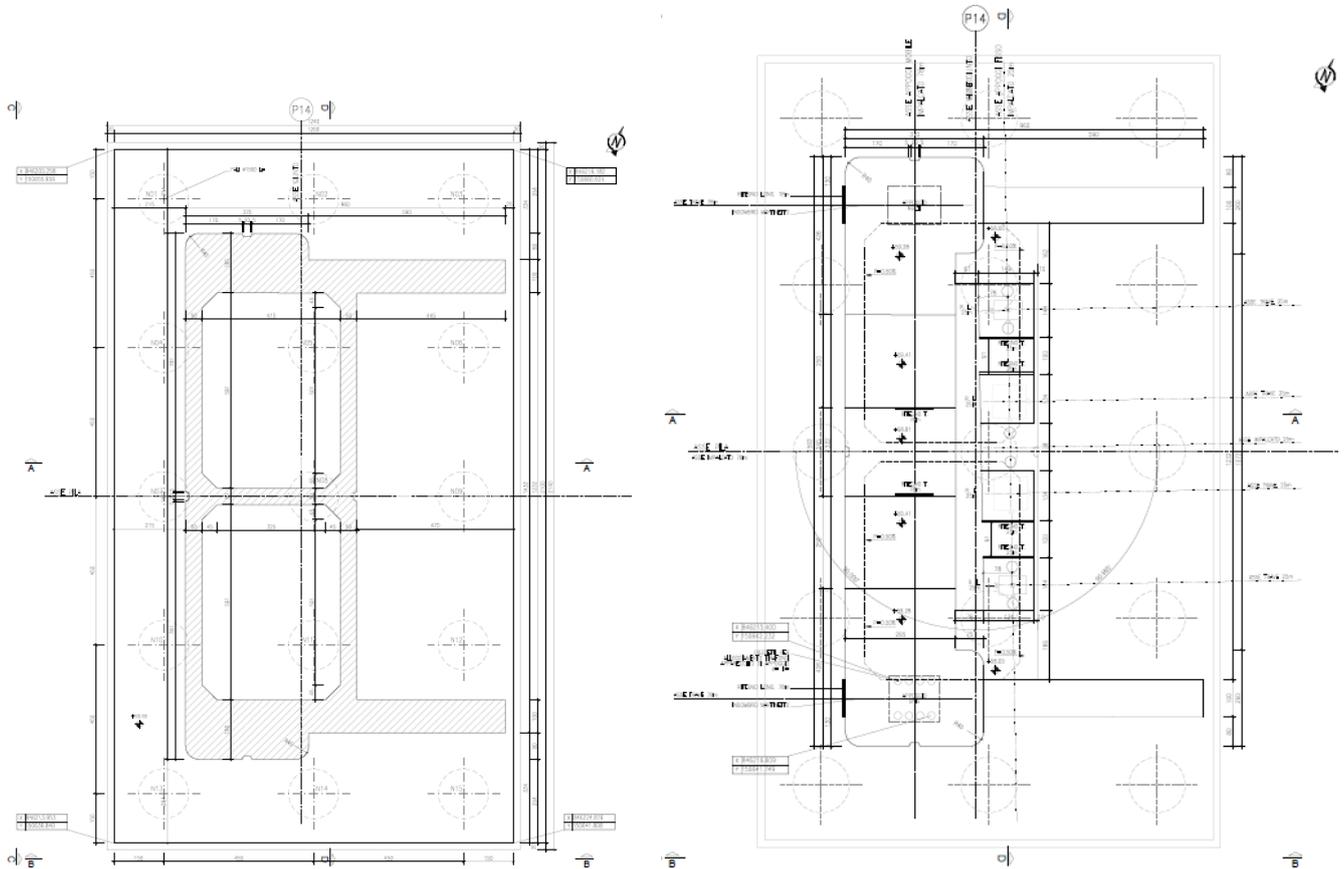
Pianta fondazioni (a sinistra) e pianta pulvino (a destra)
